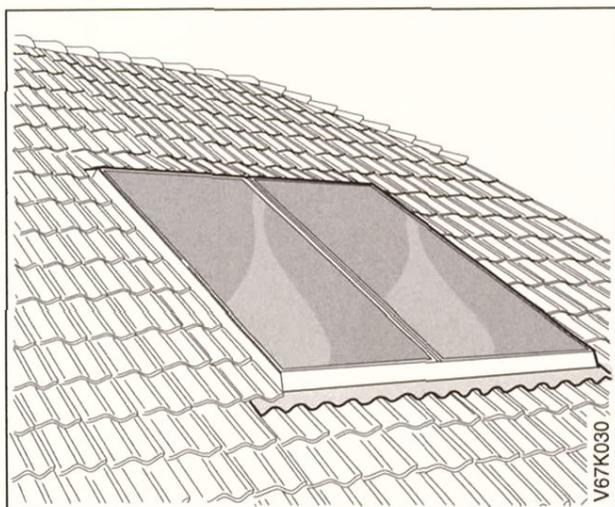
Zum Schluß Bleischürze an Ziegel anpassen. So sind die Kollektoren ansprechend ins Dach eingebunden.
